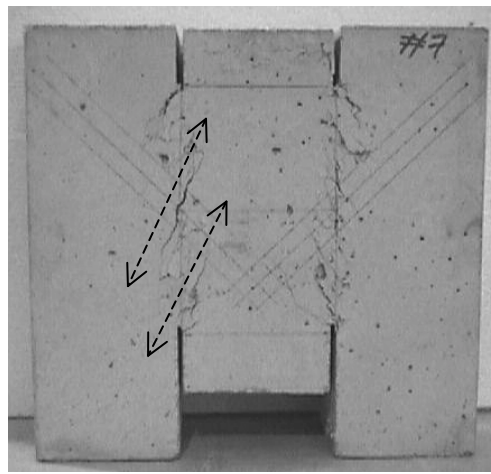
En forma similar a la Fig. 6.16 se presenta el cortante en la probeta con pequeñas fisuras paralelas a 60° sobre el plano de corte.
